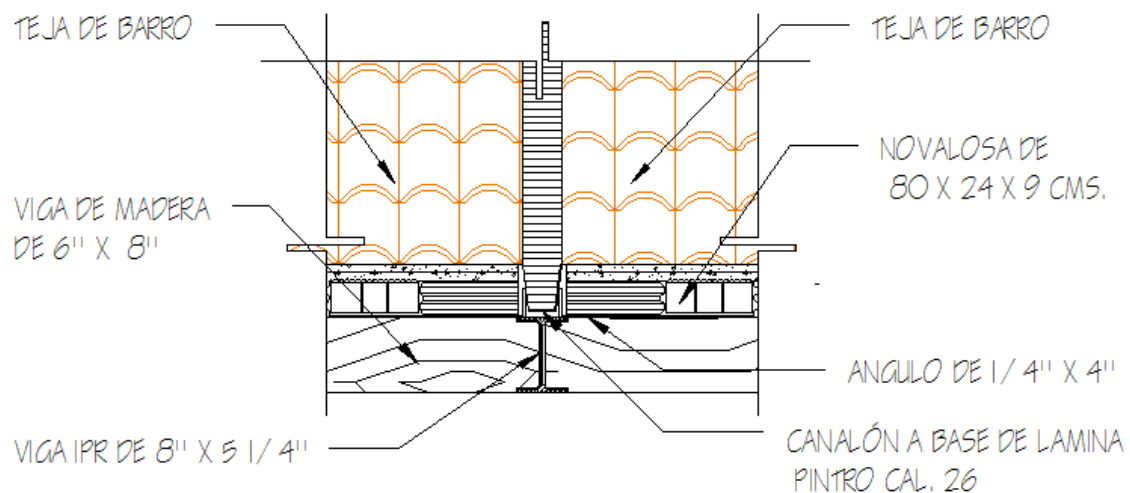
Detalle constructivo de la colocación de la viga IPR. (Detalle elaborado por Karim Alan Corona Hernández).
